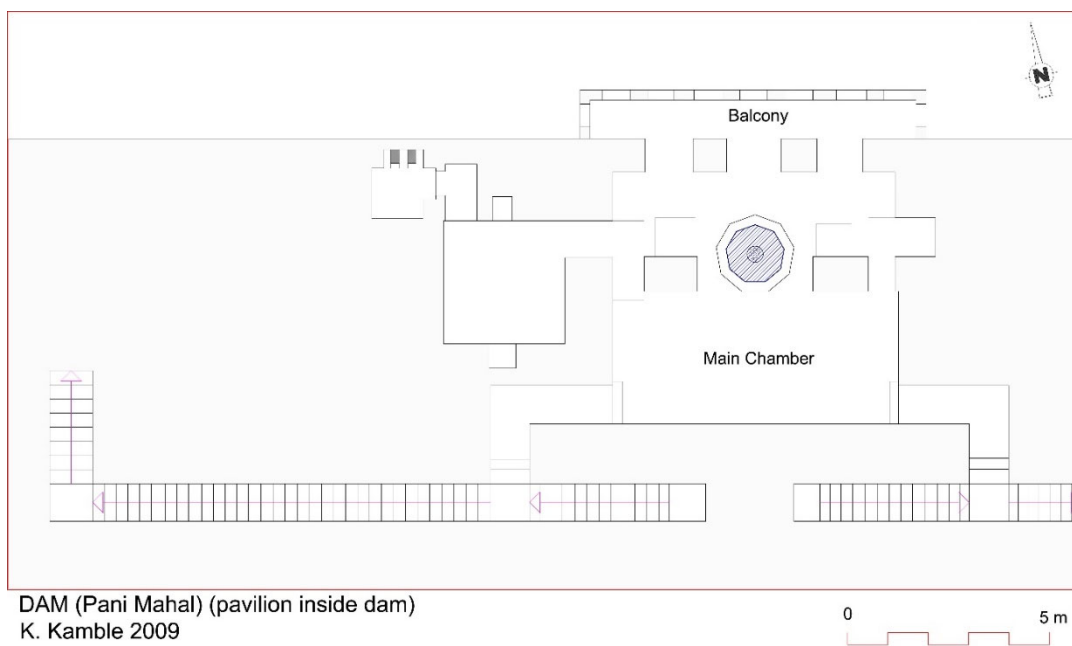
plan du *pani mahal* dans le barrage (K. Kamble, 2009)
